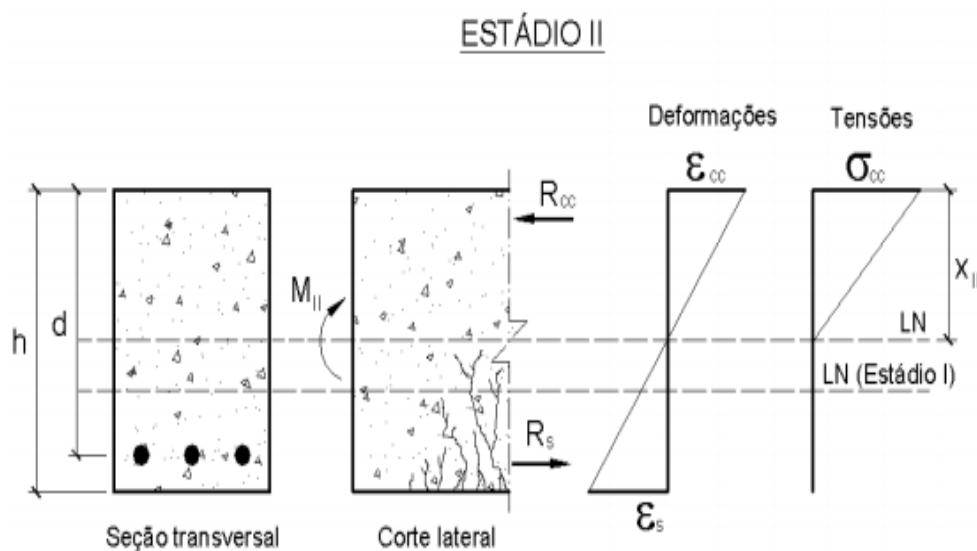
ESTÁDIO II DE FISSURAÇÃO
